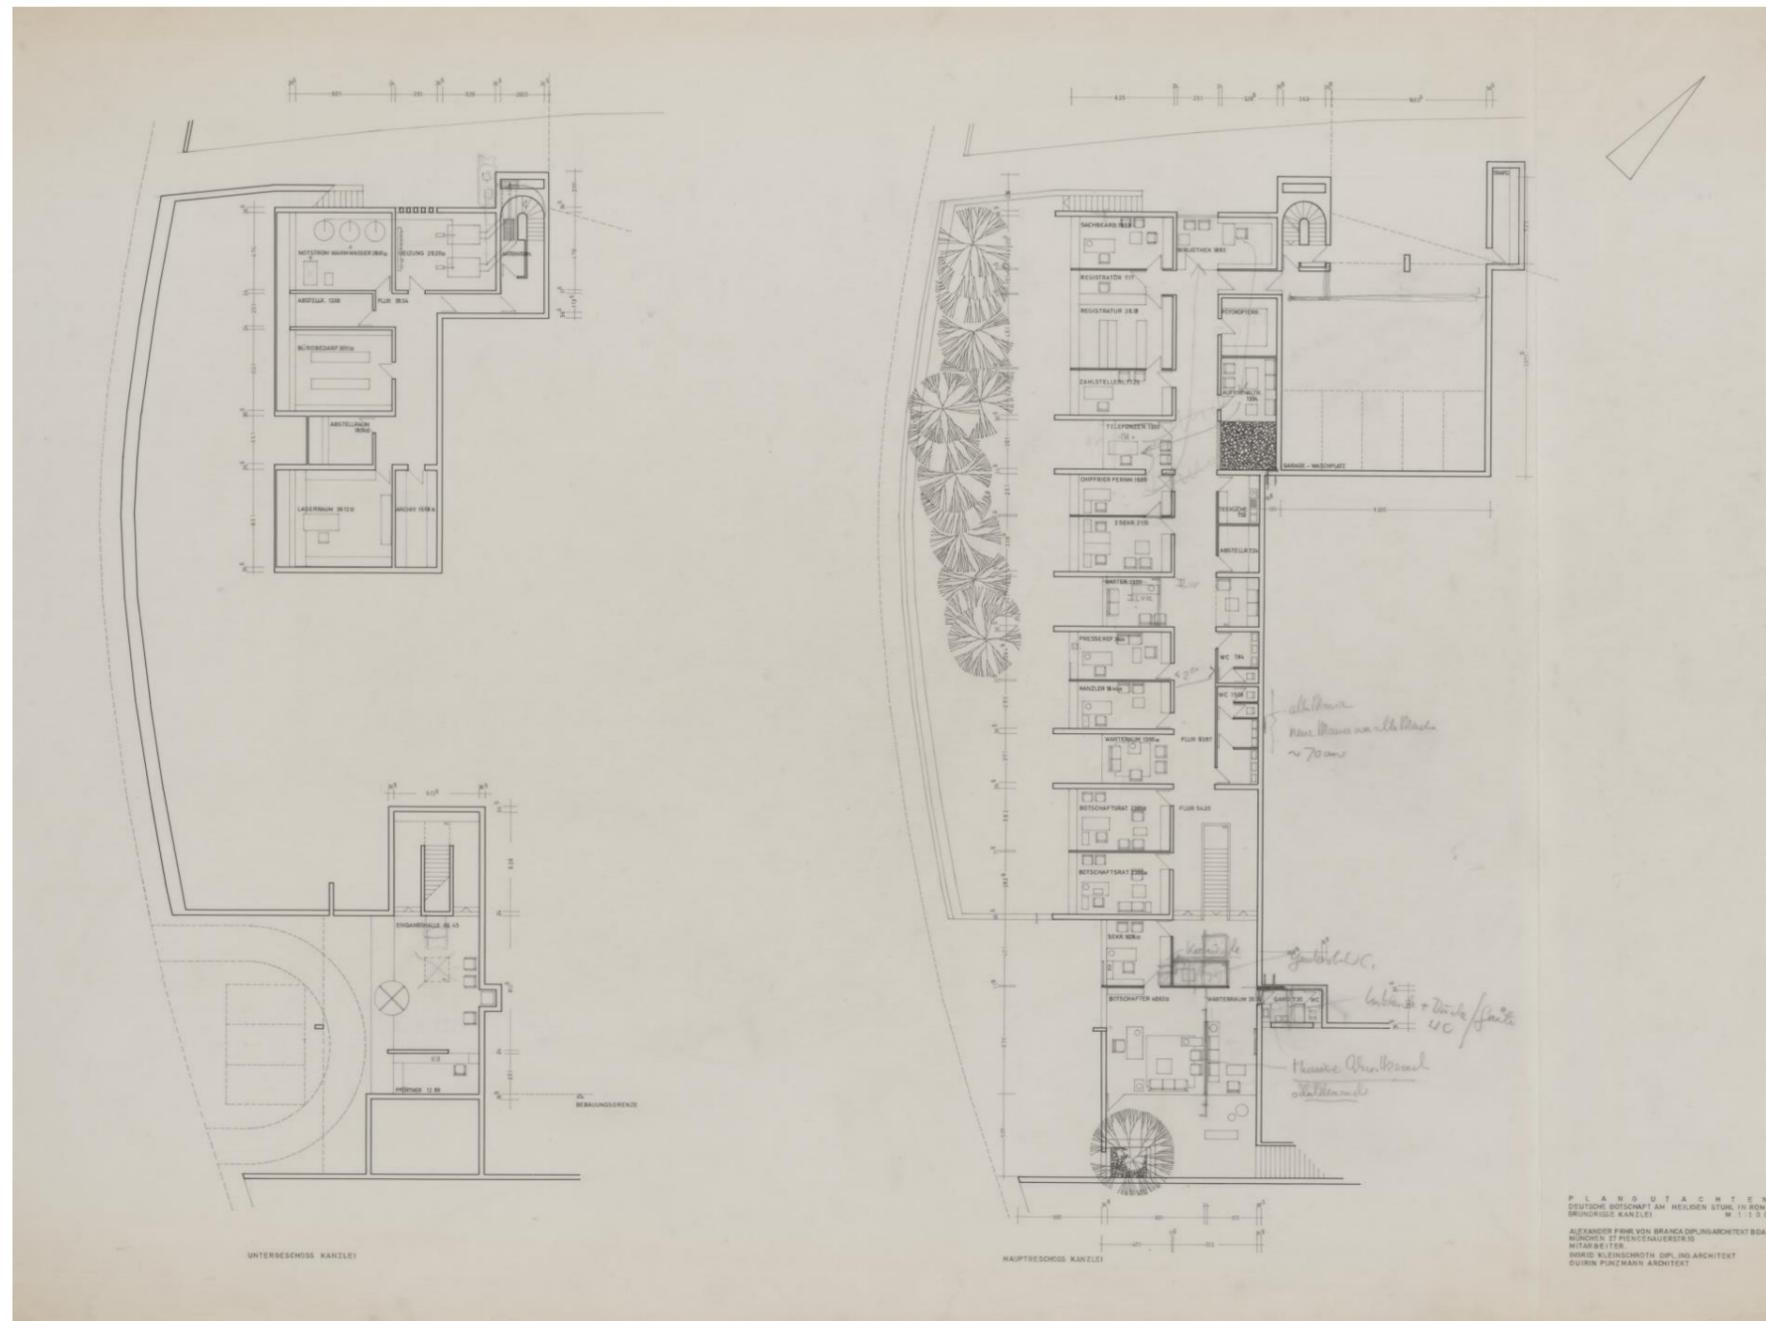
Kanzlei Plangutachten (Grundrisse UG, EG)
